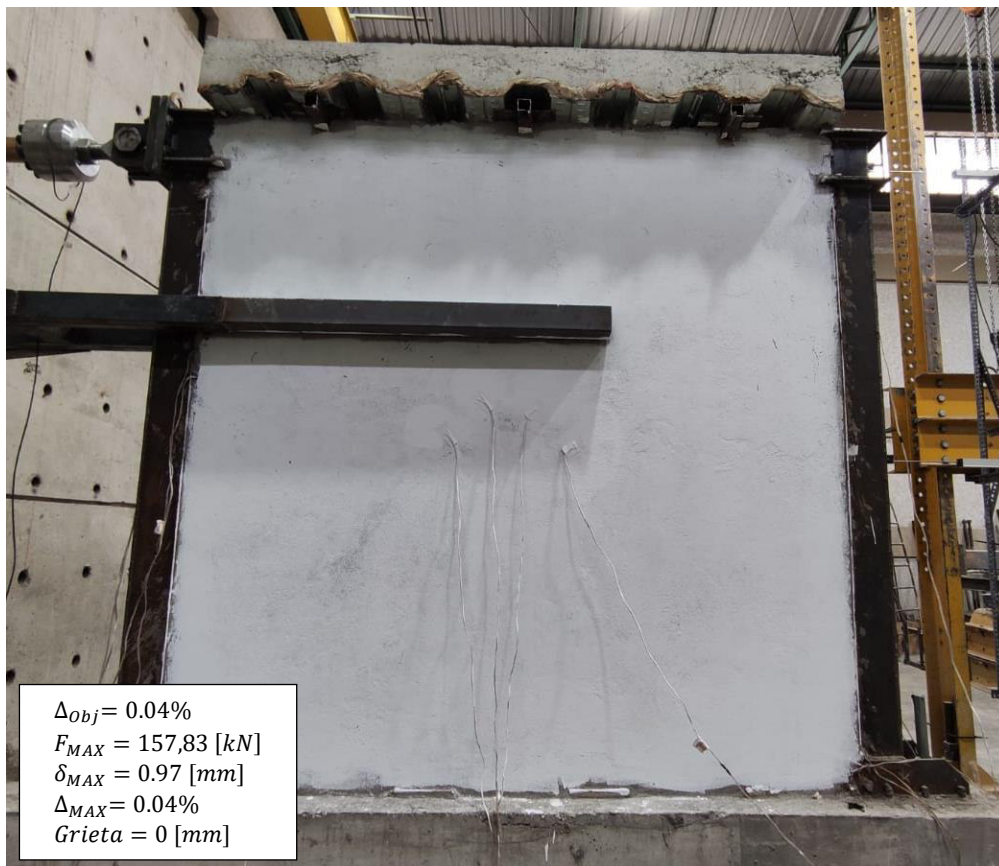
Etapa “Sin daño” de pórtico reforzado con daño previo de mampostería.
